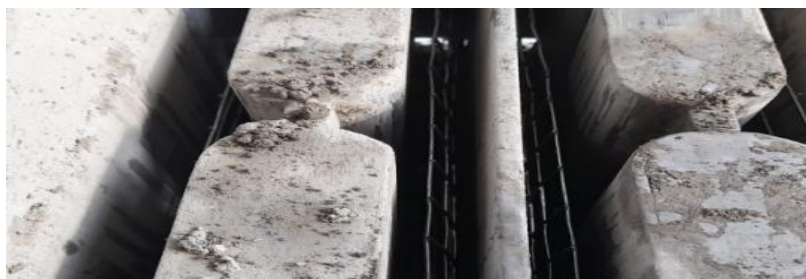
Introducción de la fibra de acero en los moldes y llenado de los moldes
